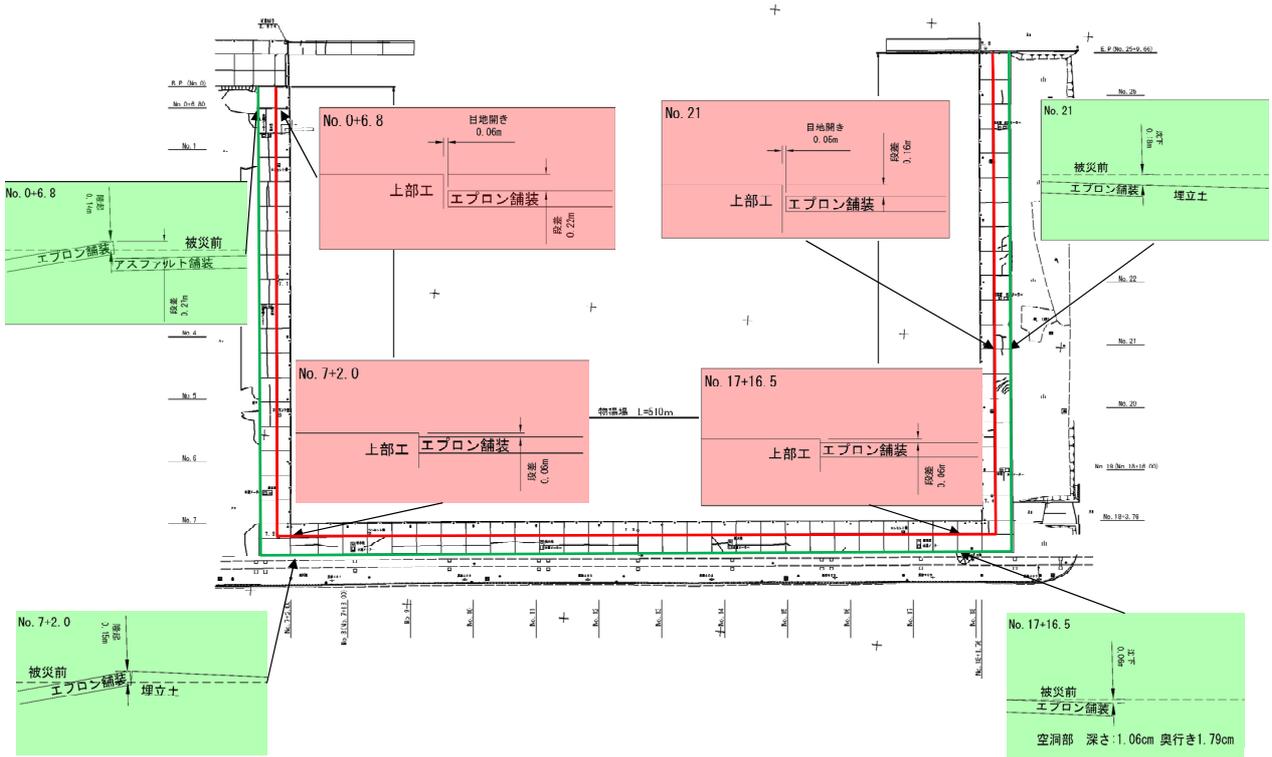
No.19 常陸那珂港区_北ふ頭地区物揚場 A,B,C の平面図 (被災後)
